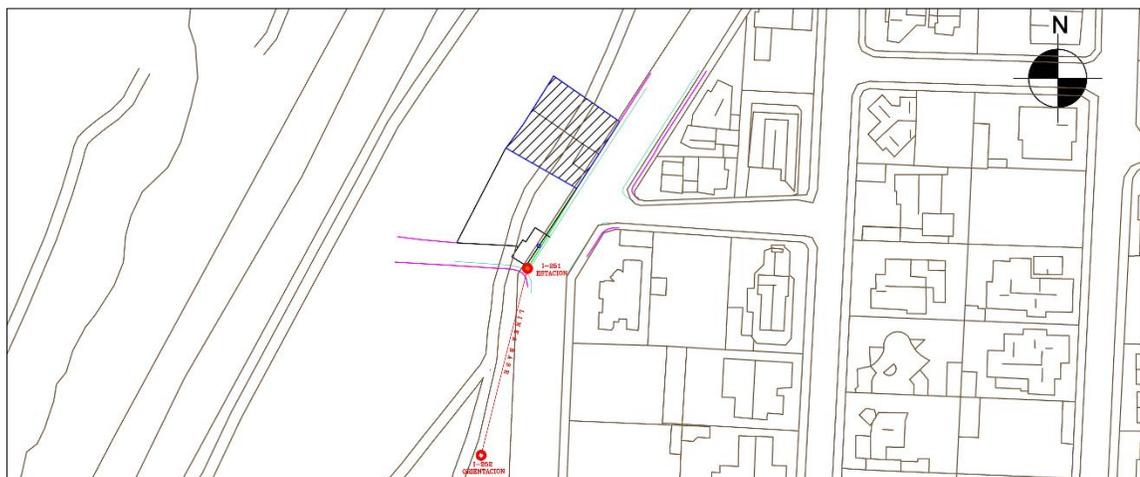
Muestra 6, Lote en la zona Irpavi
